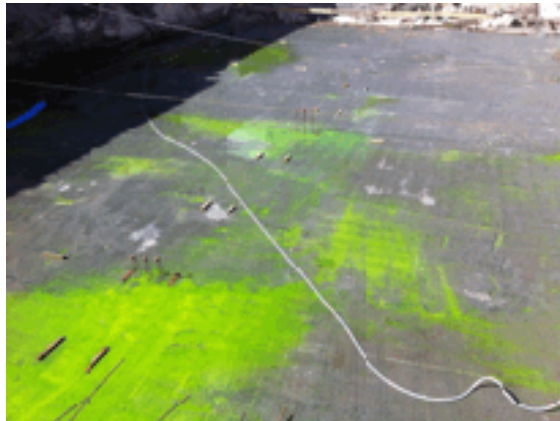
Foto de laje recém concretada com rastreador mostrando a presença do aditivo redutor de permeabilidade.
